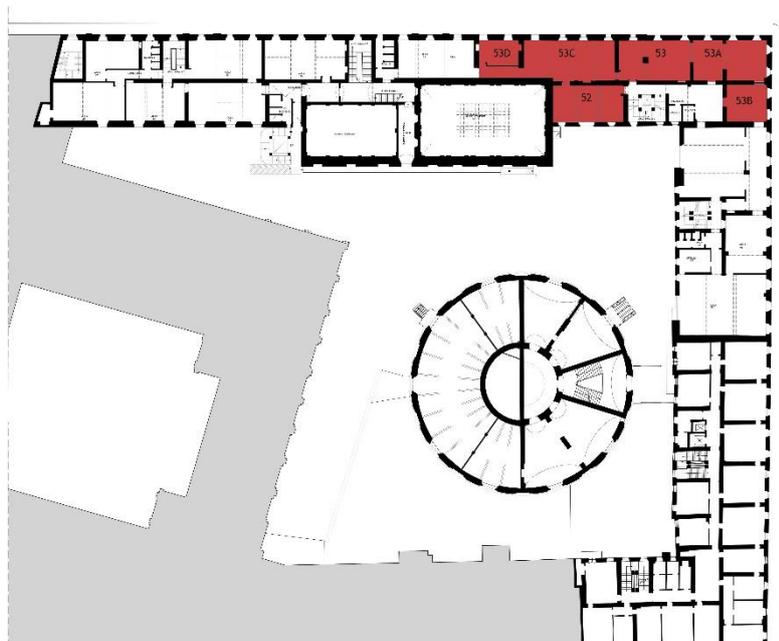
Pianta dello stato di fatto con indicazione dei locali riservati ai laboratori di Pittura, terzo piano.
